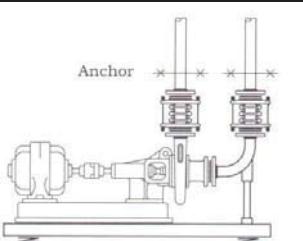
泵浦進、出口端。Pump : inlet/outlet
